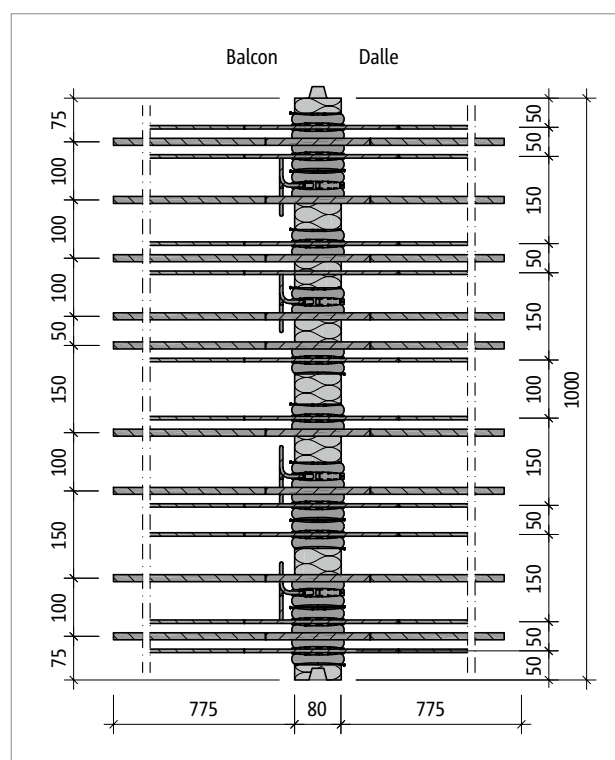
Schöck Rutherma® T type DBi-M3-V3 : vue en plan du produit
